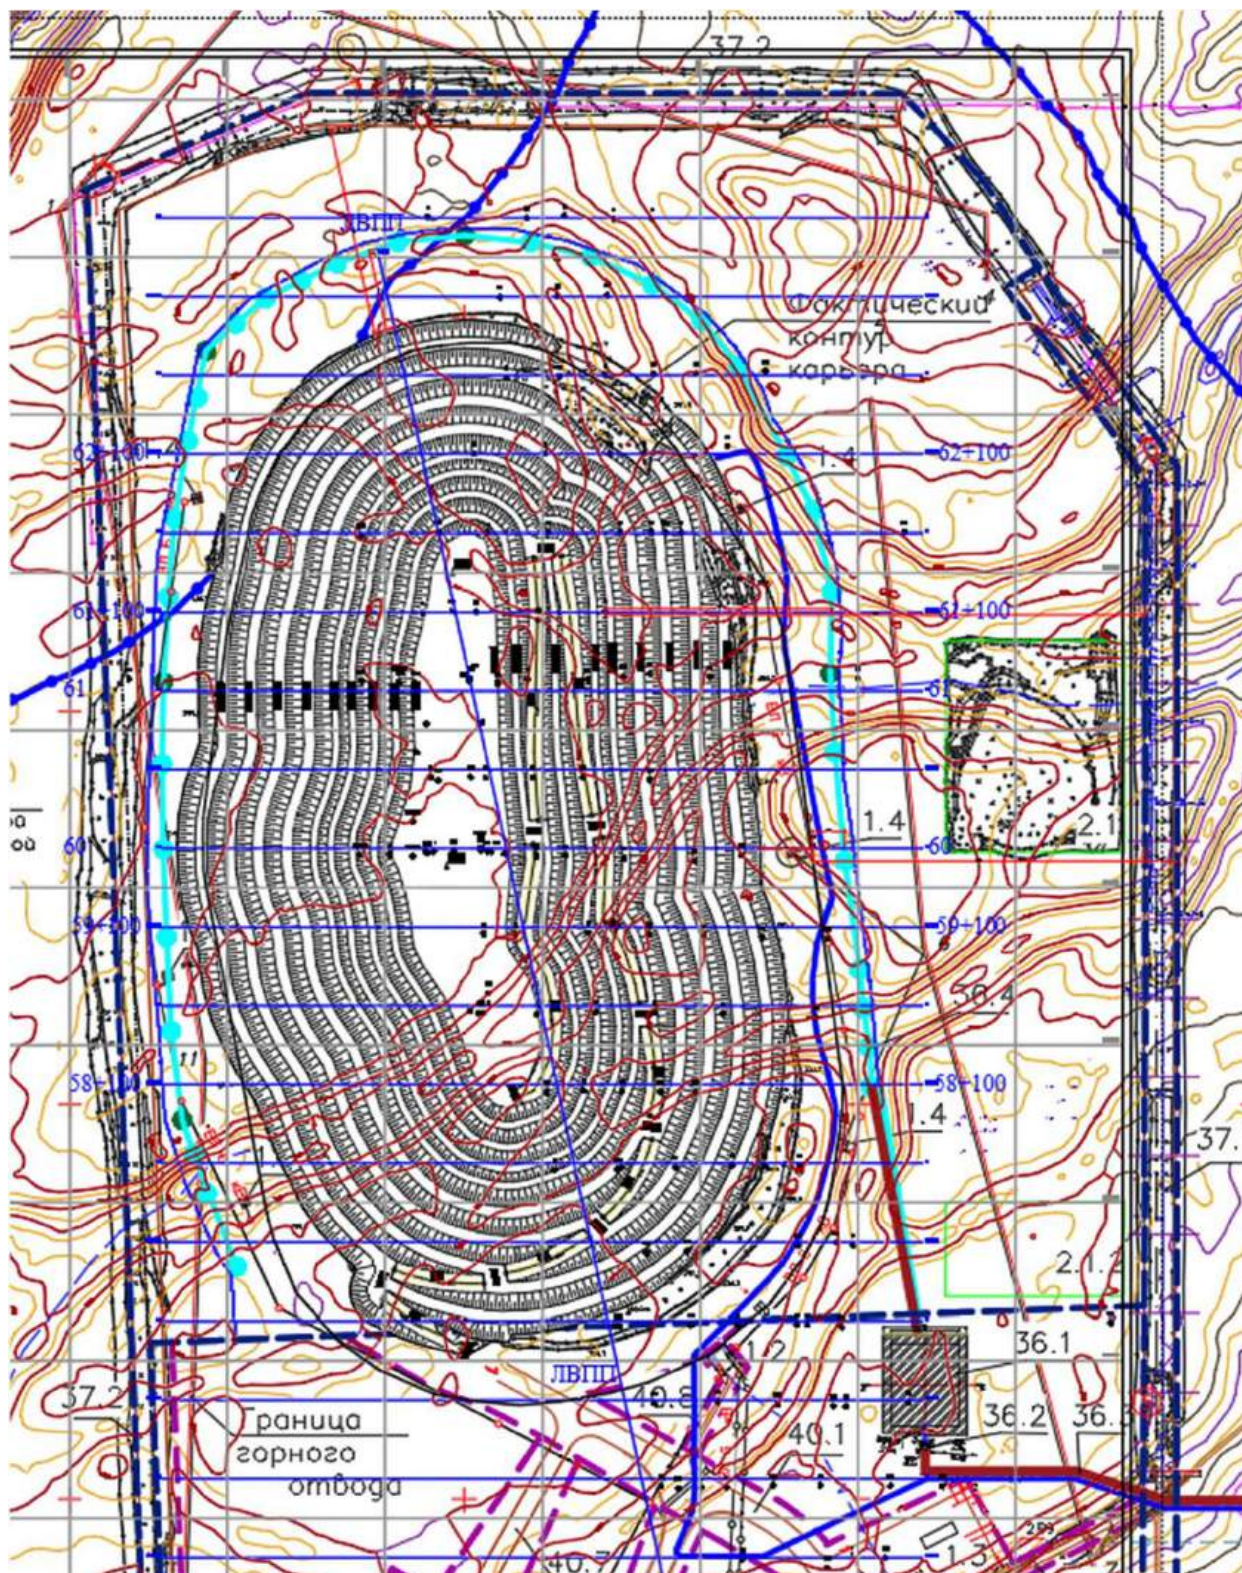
План горных работ без пригрузки из скальных пород месторождения «Лиманное»
